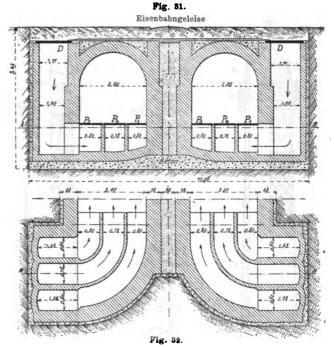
Querschnitt, Fig. 32 Grundriss der in den Zonen 3, 4 und 5 einmündenden Füchse.
